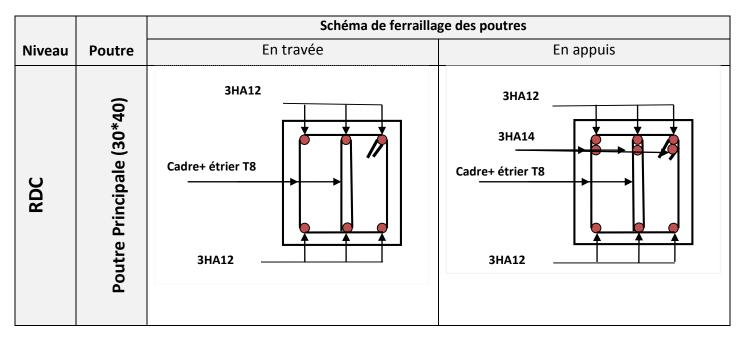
Exemple de Schéma de ferraillage d'une poutre principale.
